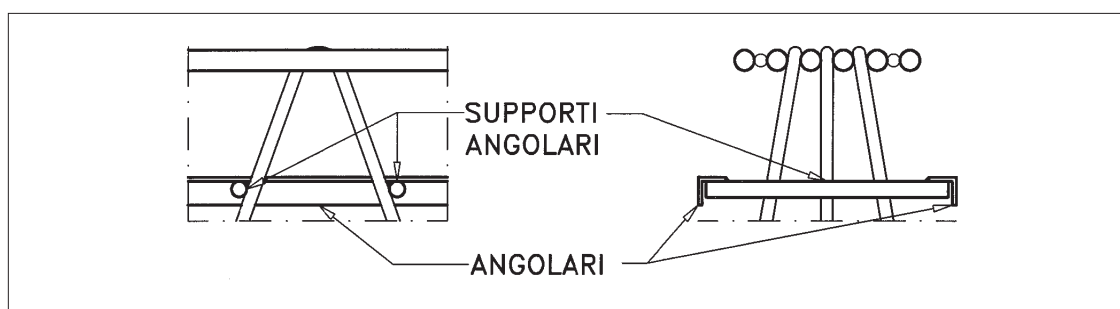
Trave con apparecchio di appoggio per solai prefabbricati.
